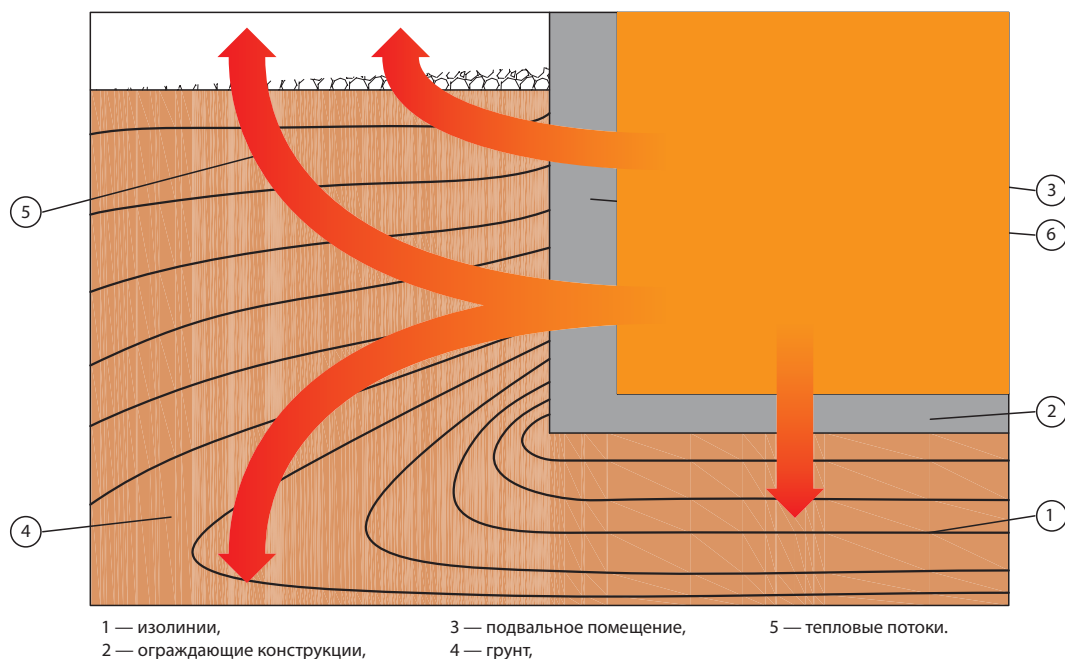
Схема тепловых потоков через основания и фундамент без теплоизоляции
